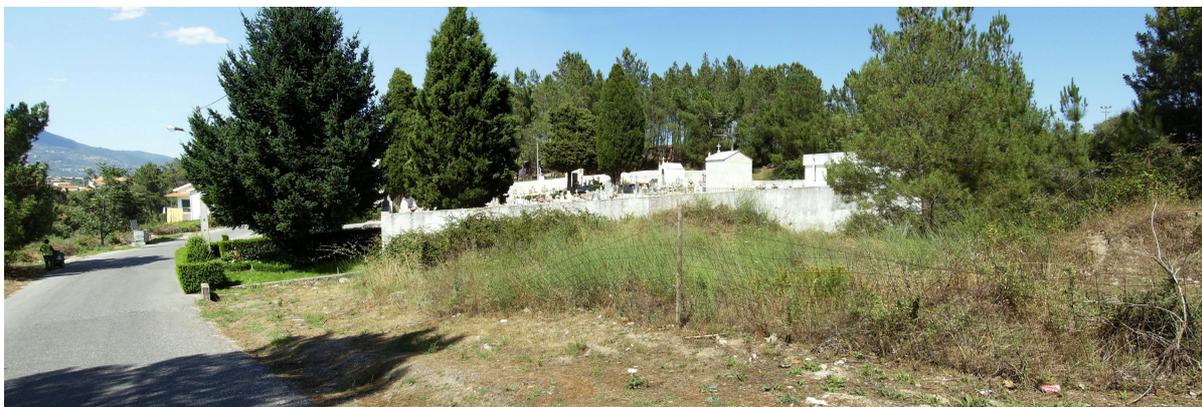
Situação atual da área de intervenção (no primeiro plano)
